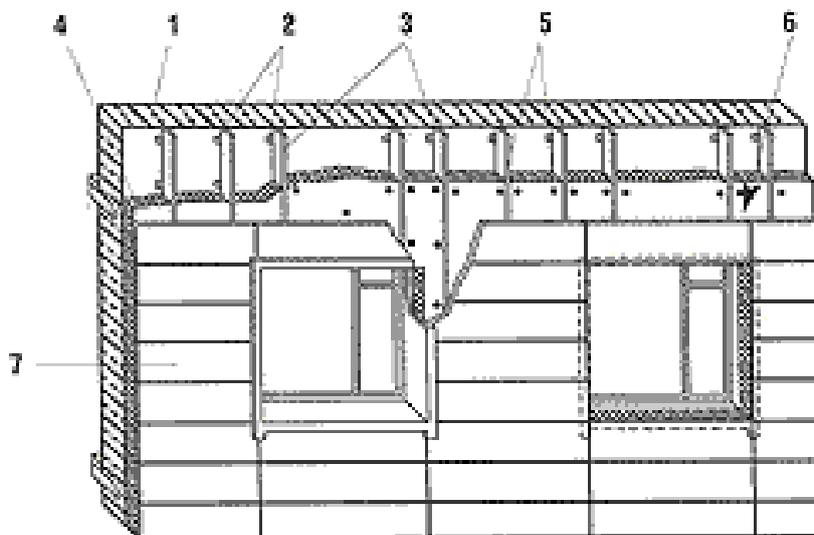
Конструкция стены с вентилируемым фасадом с навесной защитной облицовкой: 1 - стена; 2 - узлы крепления направляющих; 3 - металлические направляющие; 4 - утеплитель, с ветрозащитным материалом; 5 - дюбели; 6 - воздушная прослойка; 7 - наружная облицовка.
